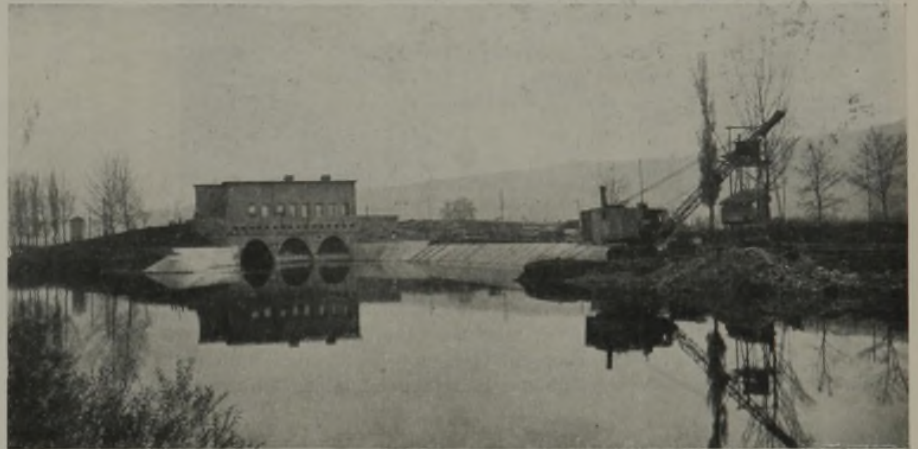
Staustufe Obereßlingen. Kraftwerk mit Unterkanal.
